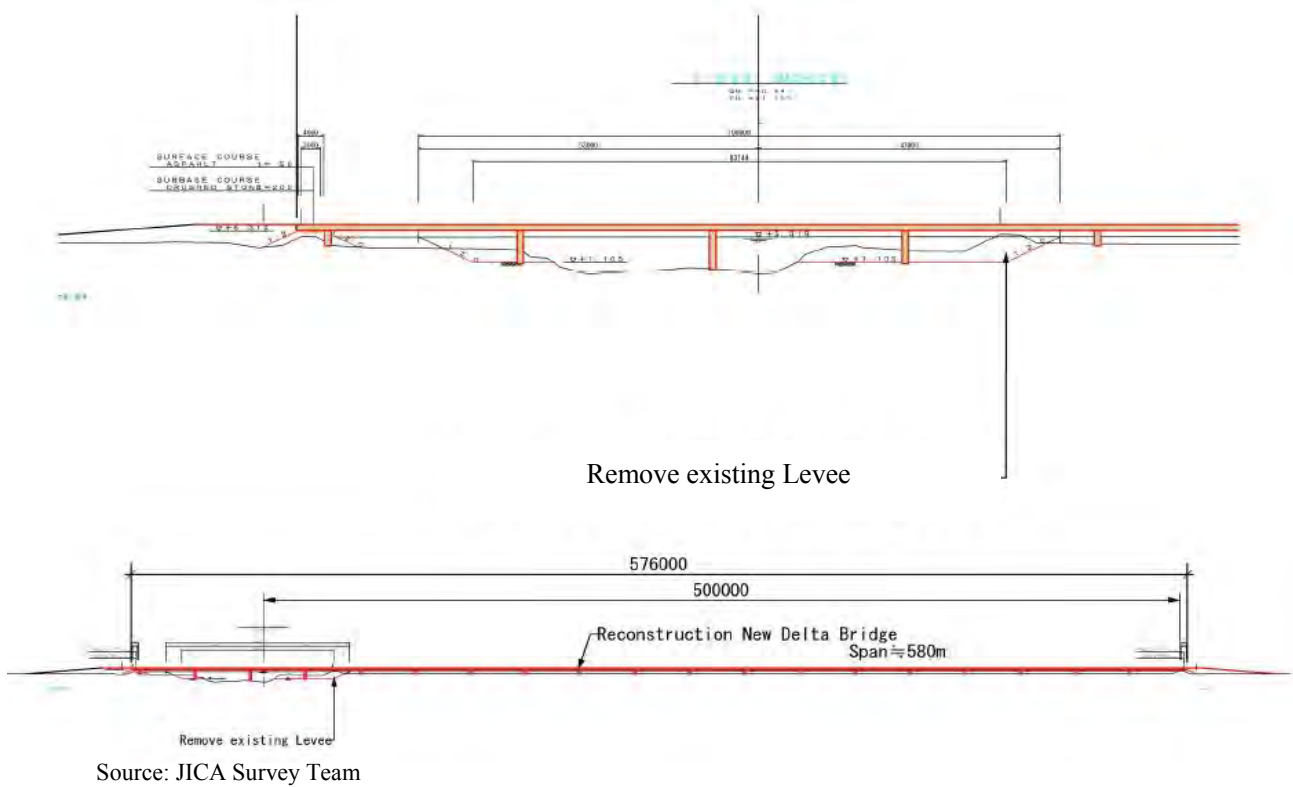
K.LANDAOUS BRIDGE 架け替え諸元
